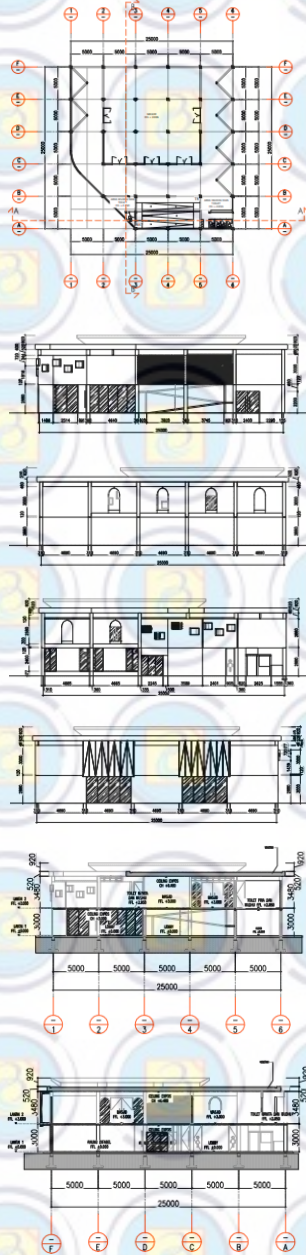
8 Denah, tampak, dan potongan massa bangunan perpustakaan
